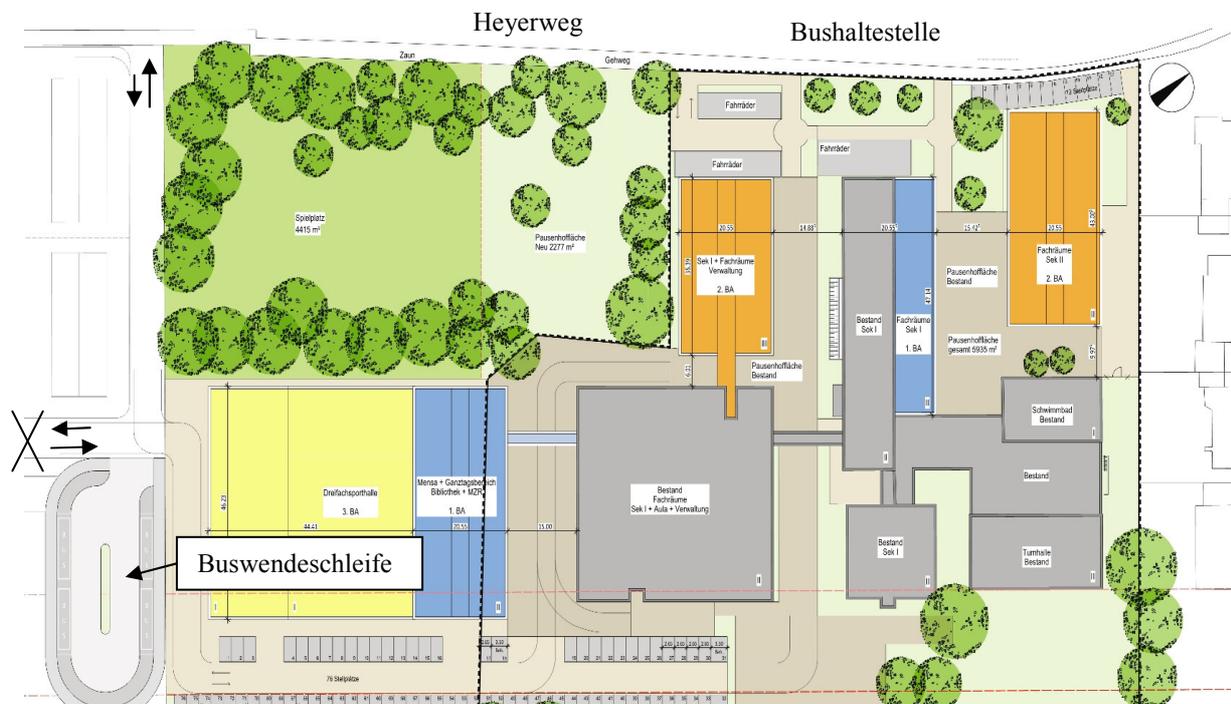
Grundriss der neuen Gesamtschule mit Haltestelle und Buswendeschleife (ohne Anbindung an das Neubaugebiet)
